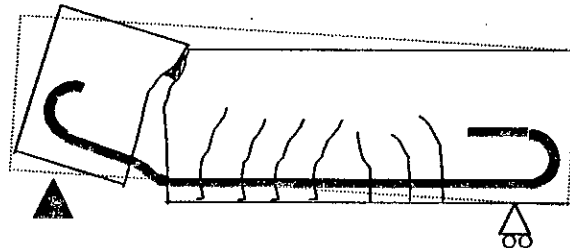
fissuration lors de la rupture par cisaillement-glissement.
